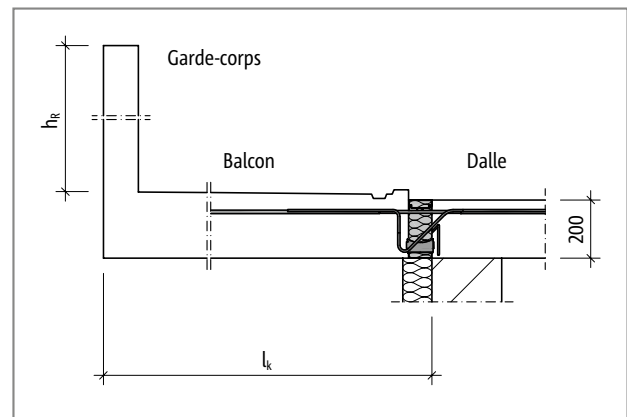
Schöck Isokorb® T Type K-E, K-T : Système statique, coupe
